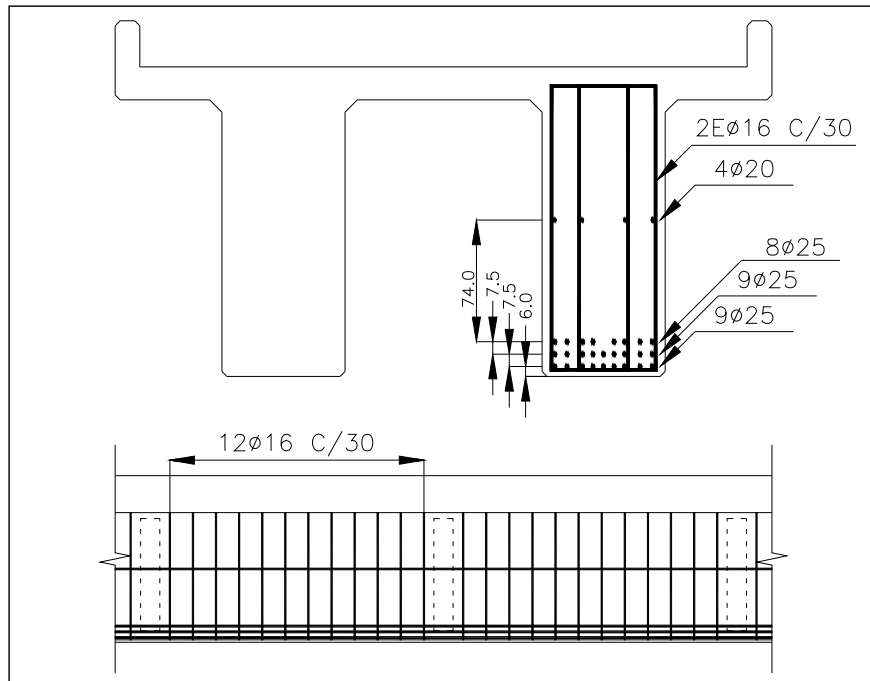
Esquema transversal e longitudinal das armaduras das vigas longarinas na região dos vãos (áreas 1, 2, 4, 6, 7 e 8).
